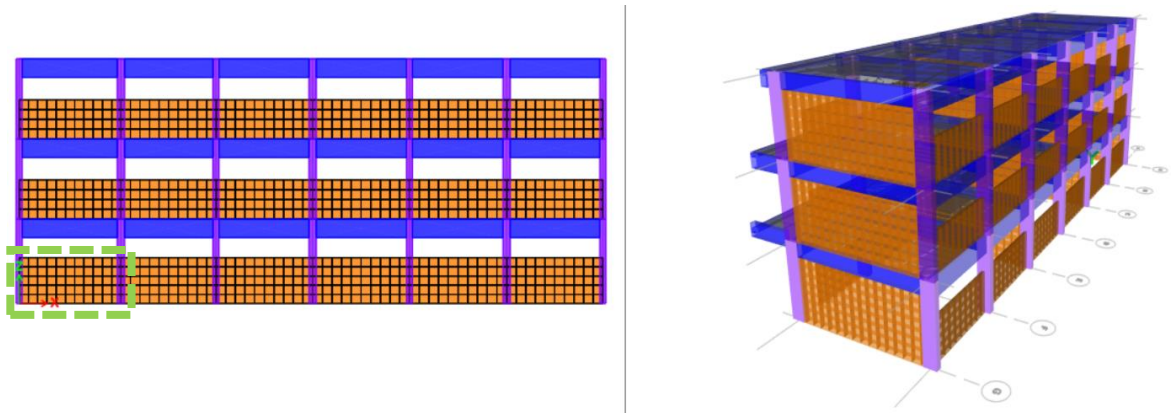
Muro fisurado AB del Piso 1, bloque 1
